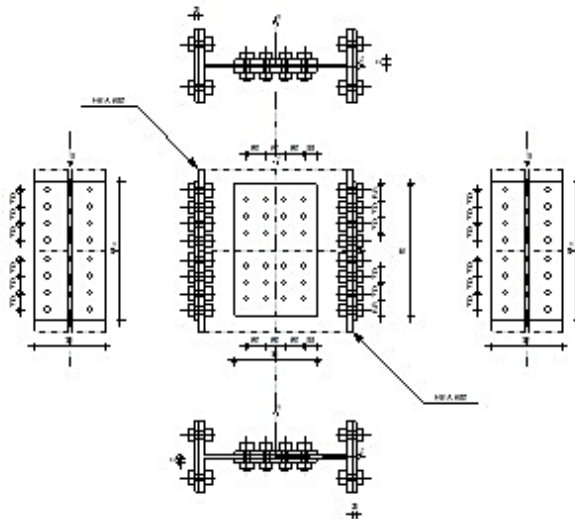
2 : Vérification de l'assemblage poteau-poteau
